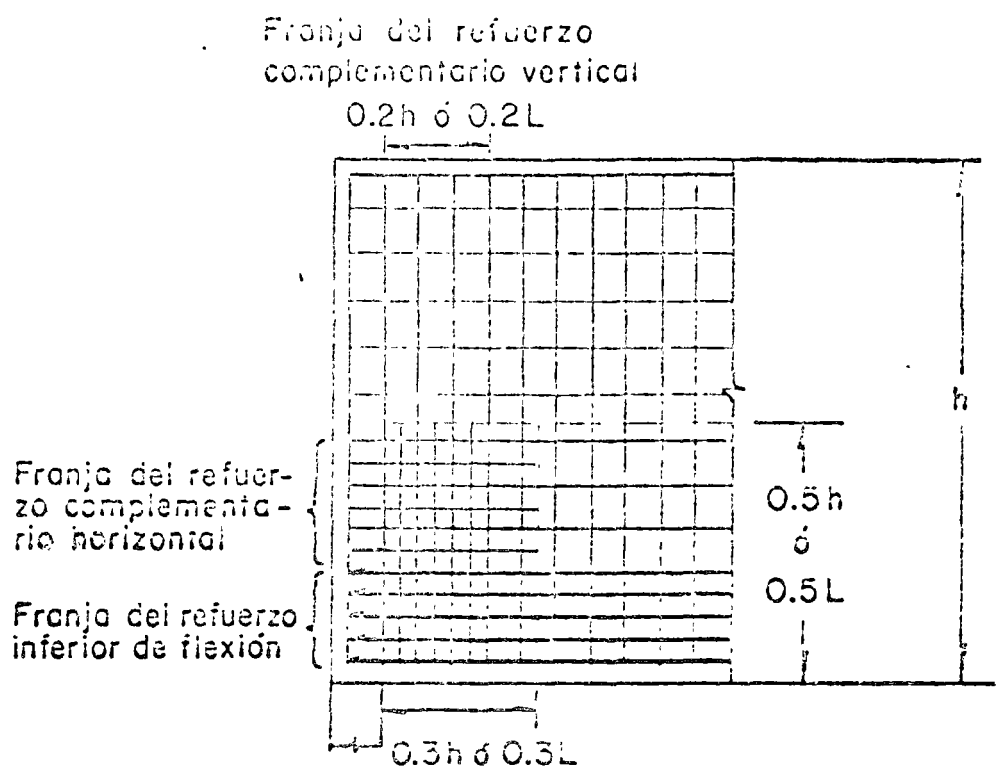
Refuerzo complementario en una zona de apoyo directo de una viga diafragma no atiesada
